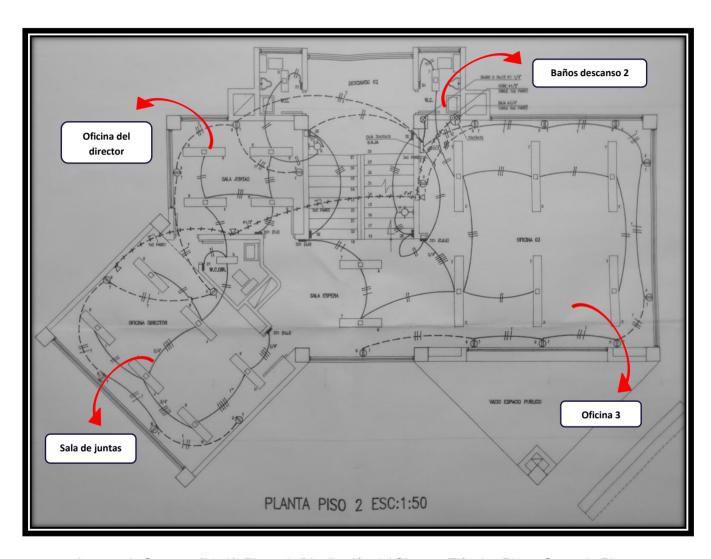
Cornare. (2008). Plano de Distribución del Sistema Eléctrico Planta Segundo Piso.
